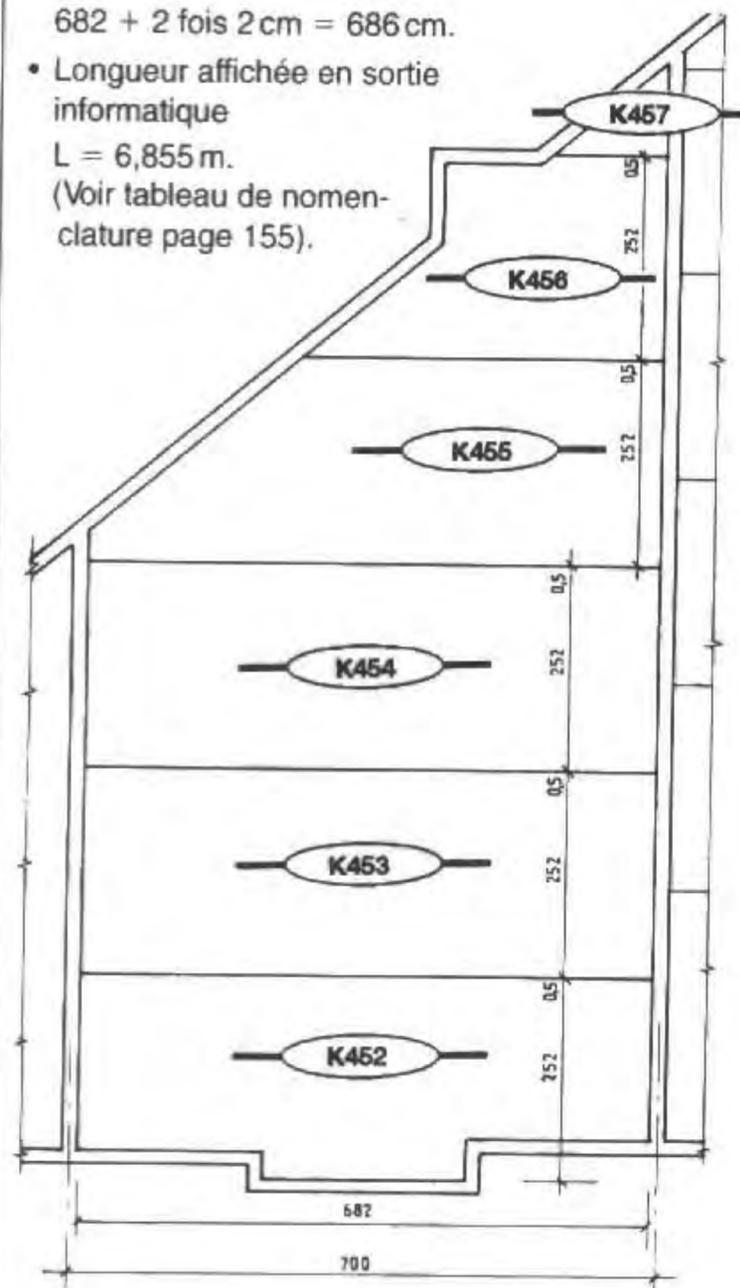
Plan d'implantation des prédalles extrait du plancher de la page 148
